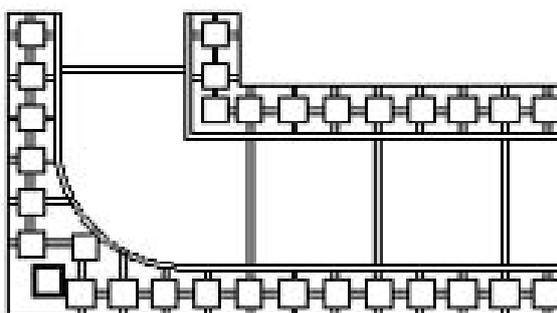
Угловой элемент теплоизоляционной опалубки «ABS»
